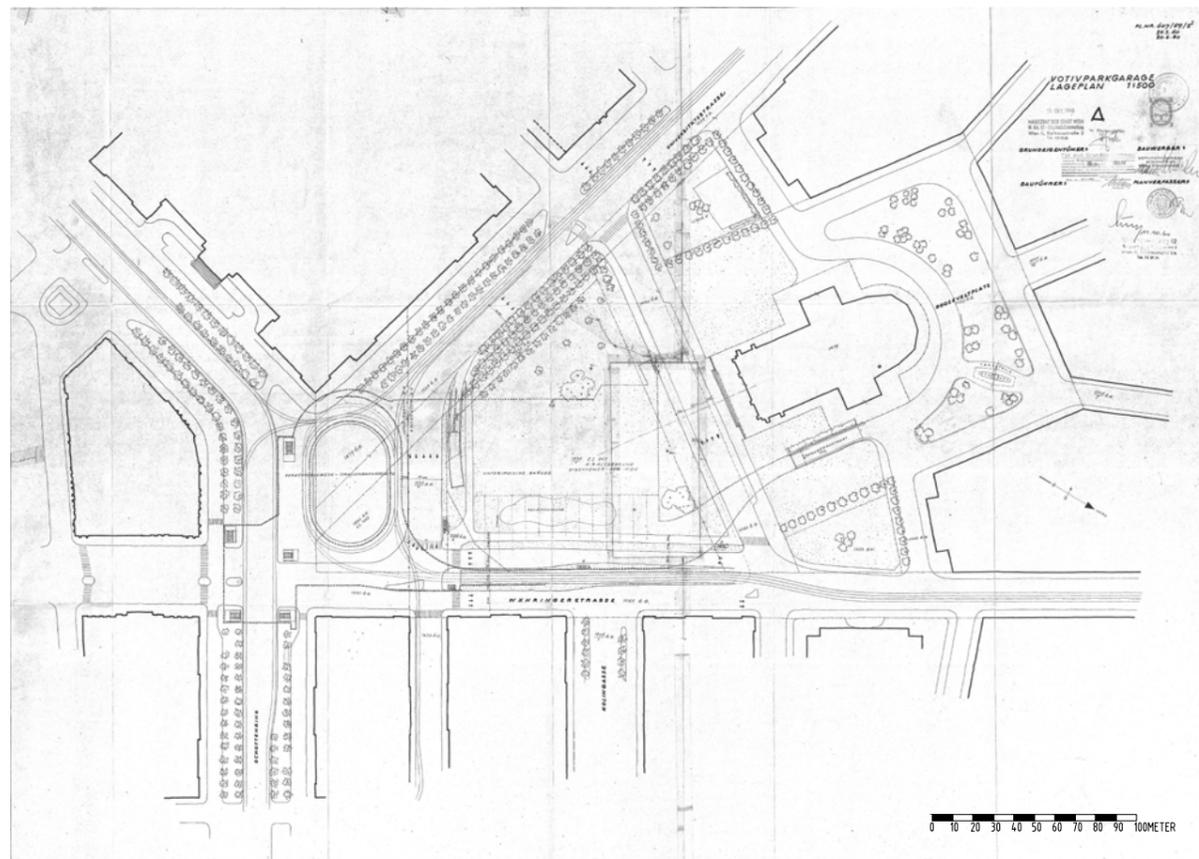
Lageplan Einreichung Umbau Jonas Reindl & Votivparkgarage 13.10.1960 © wipark
